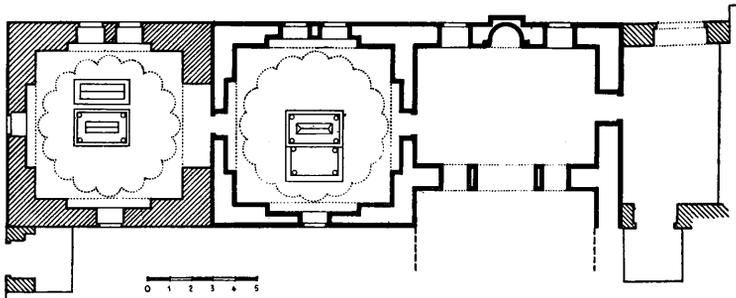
MADRASA DJAHÂRKASIYA : Plan (état actuel)
